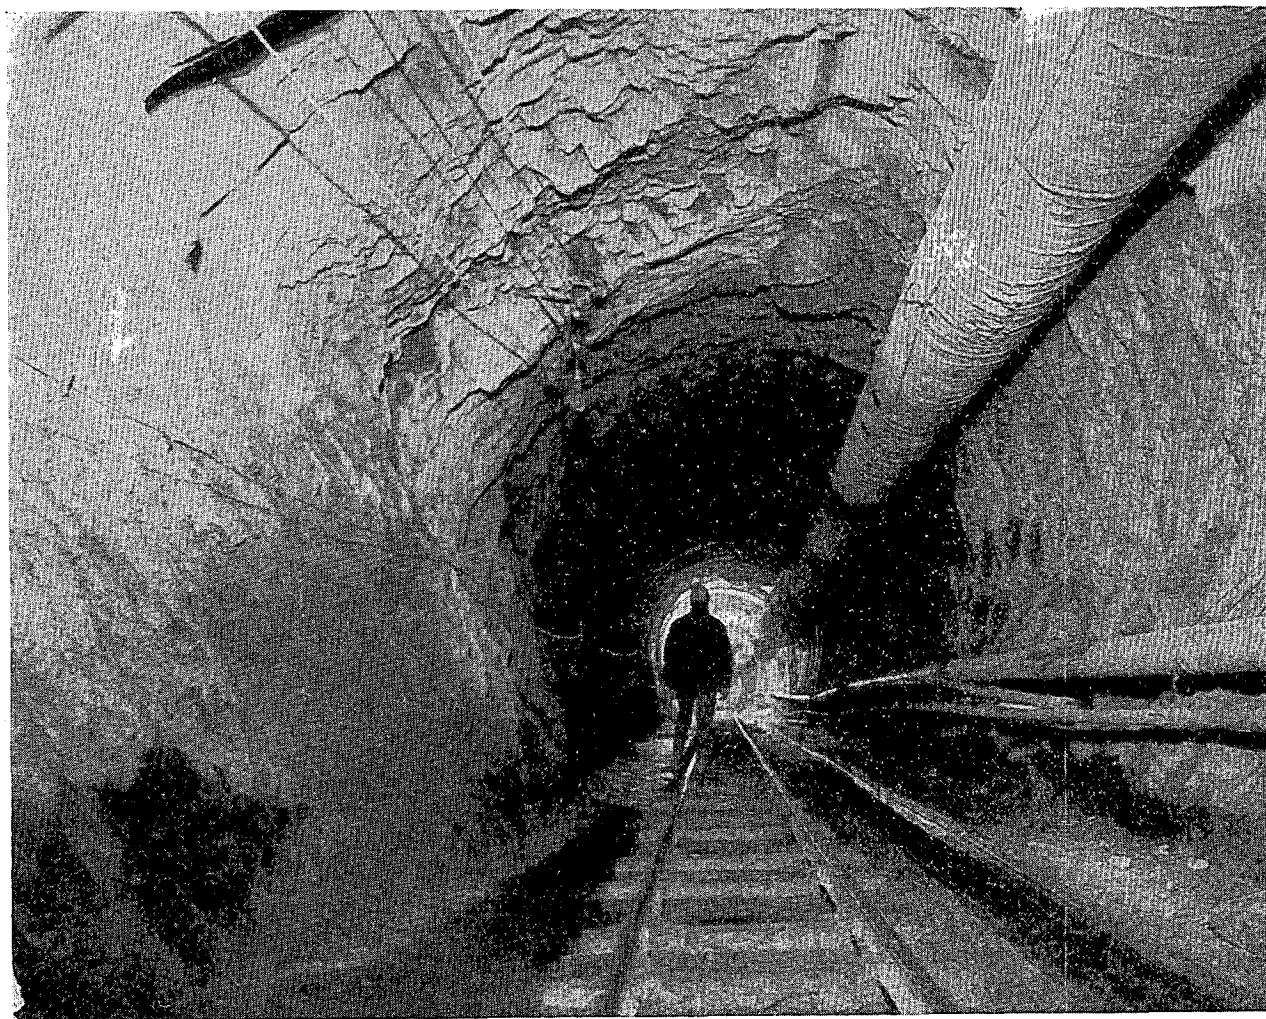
Tramo gunitado. Al fondo, entibación metálica.
